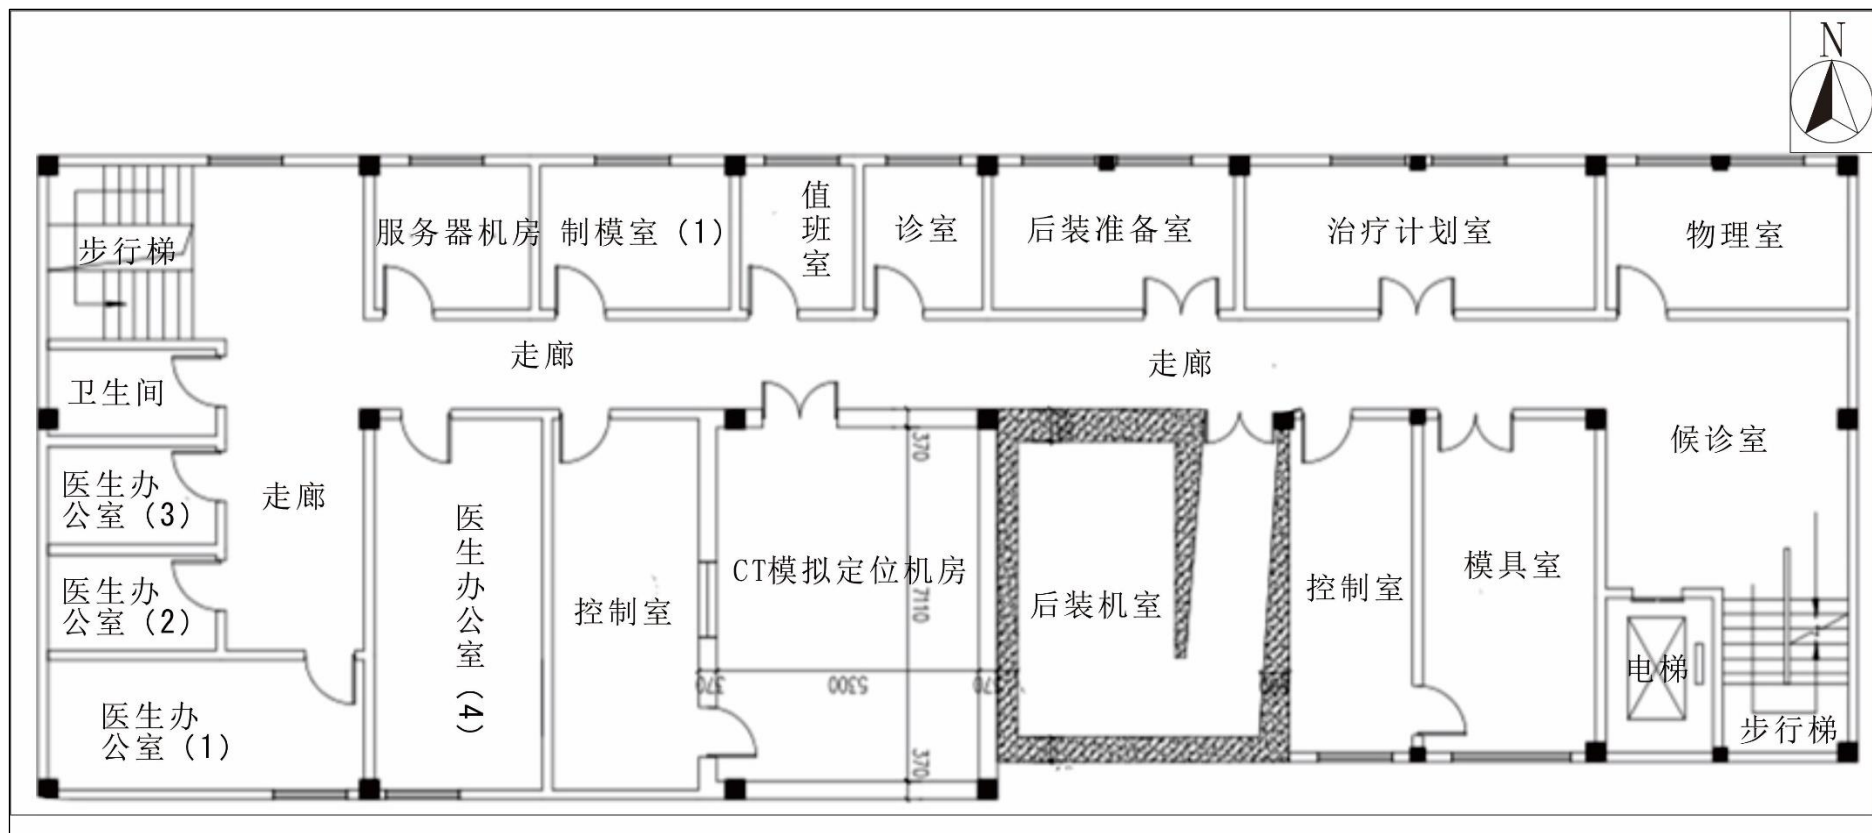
直线加速器机房 (2) 上方楼层 (二层) 平面图
